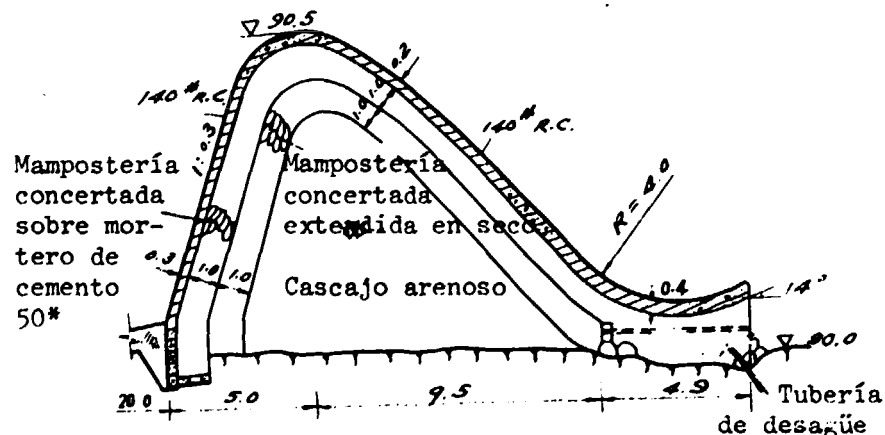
Sección transversal de una presa de estructura dura de mampostería
